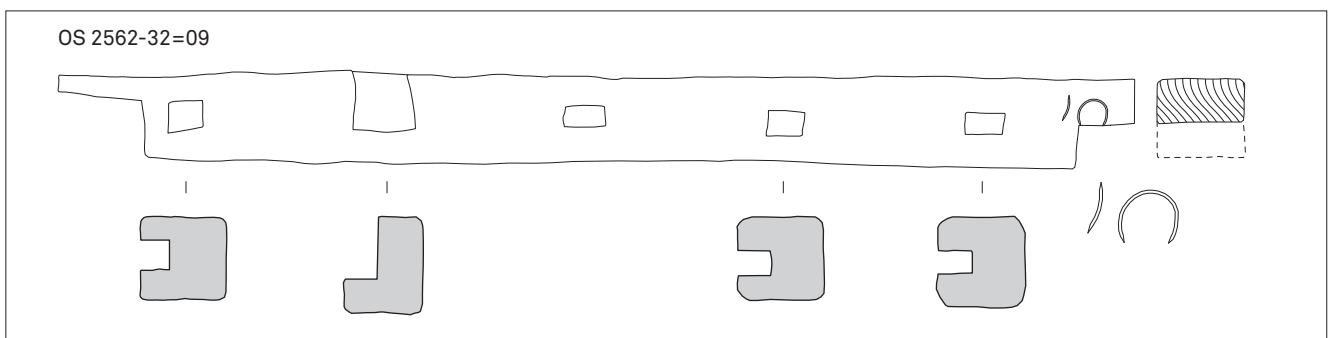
Balk OS 2562-32=09 van de buitenbekisting. Schaal 1:20, detail 1:10.
